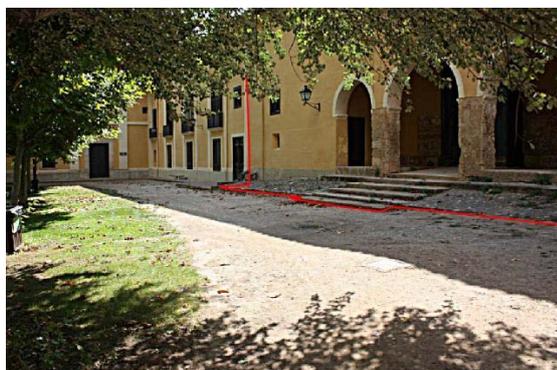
(Proyecto Inst. Humi-Stop, OCT 2009, AJS). Planta de la instalación.
